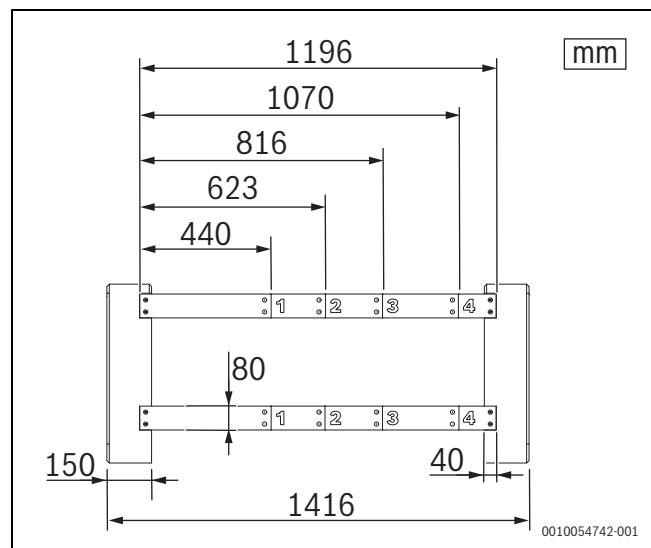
Dimensions de la fondation préfabriquée (assemblée)
